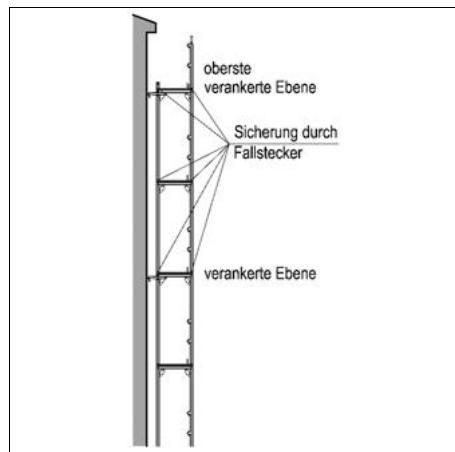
Gerüst an Gebäude mit geringer Dachneigung
